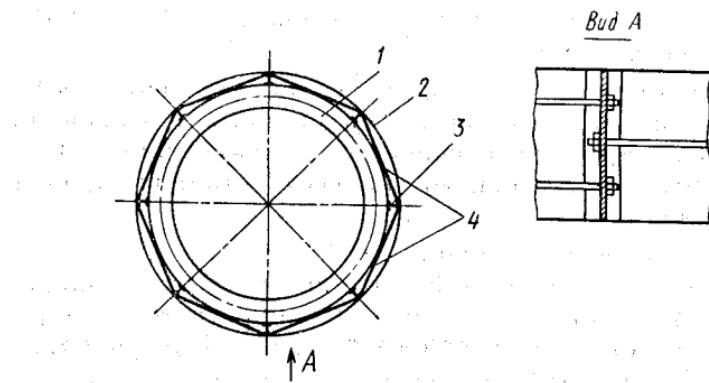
Усиление хранилищ преднапряженной обоймой:
